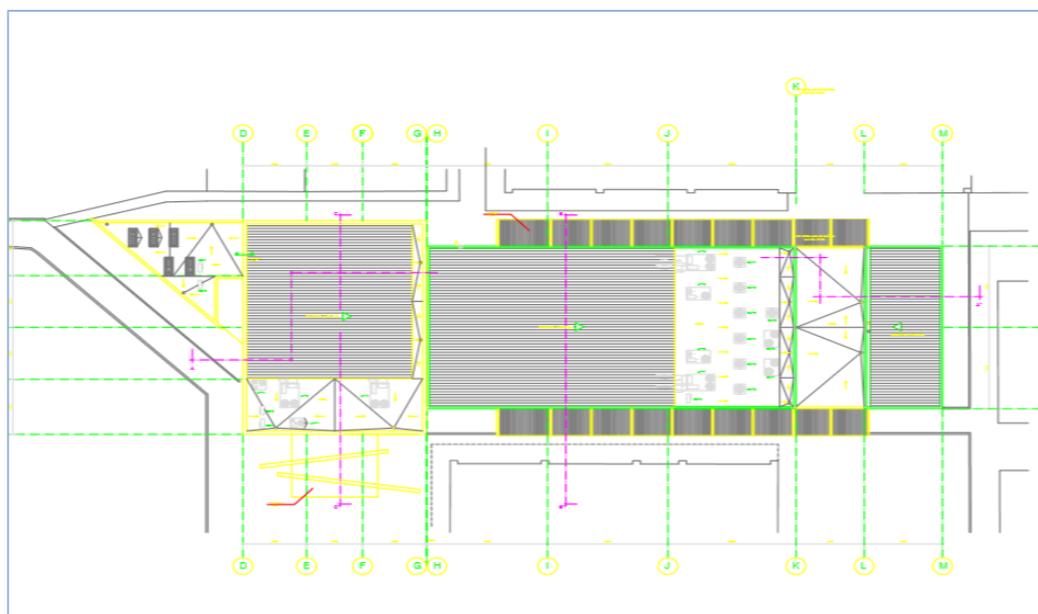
Planos Bloque E, Auditorio – Zona 3
